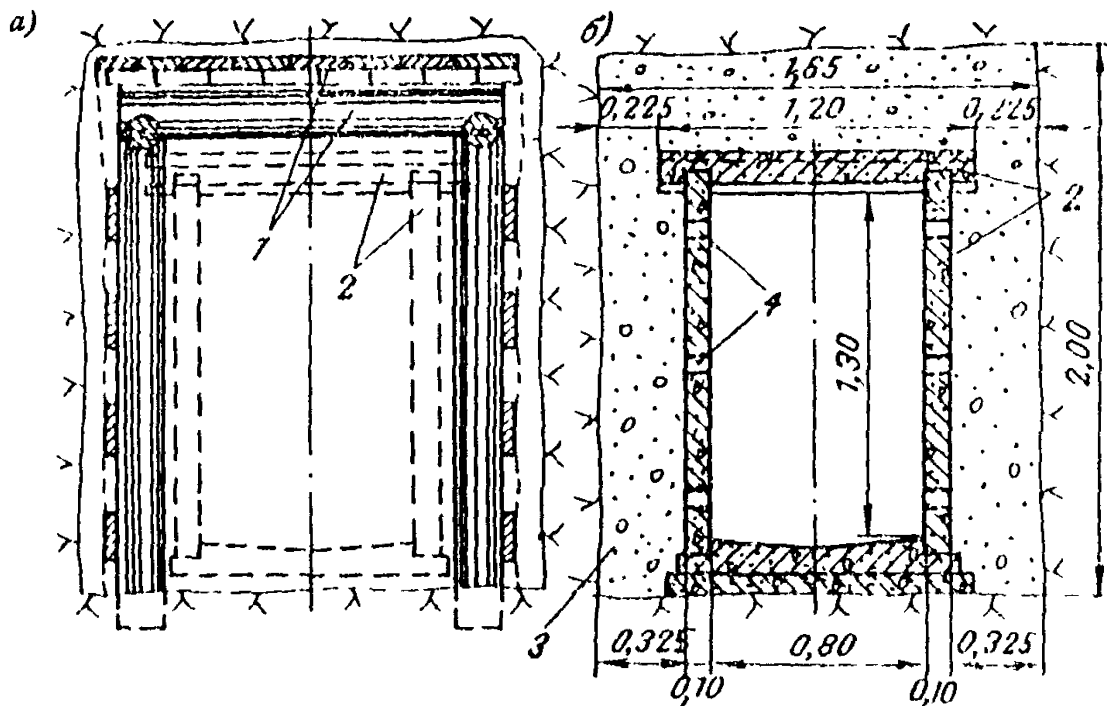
Конструкция дренажного туннеля из сборных железобетонных элементов, [Л. 29]
